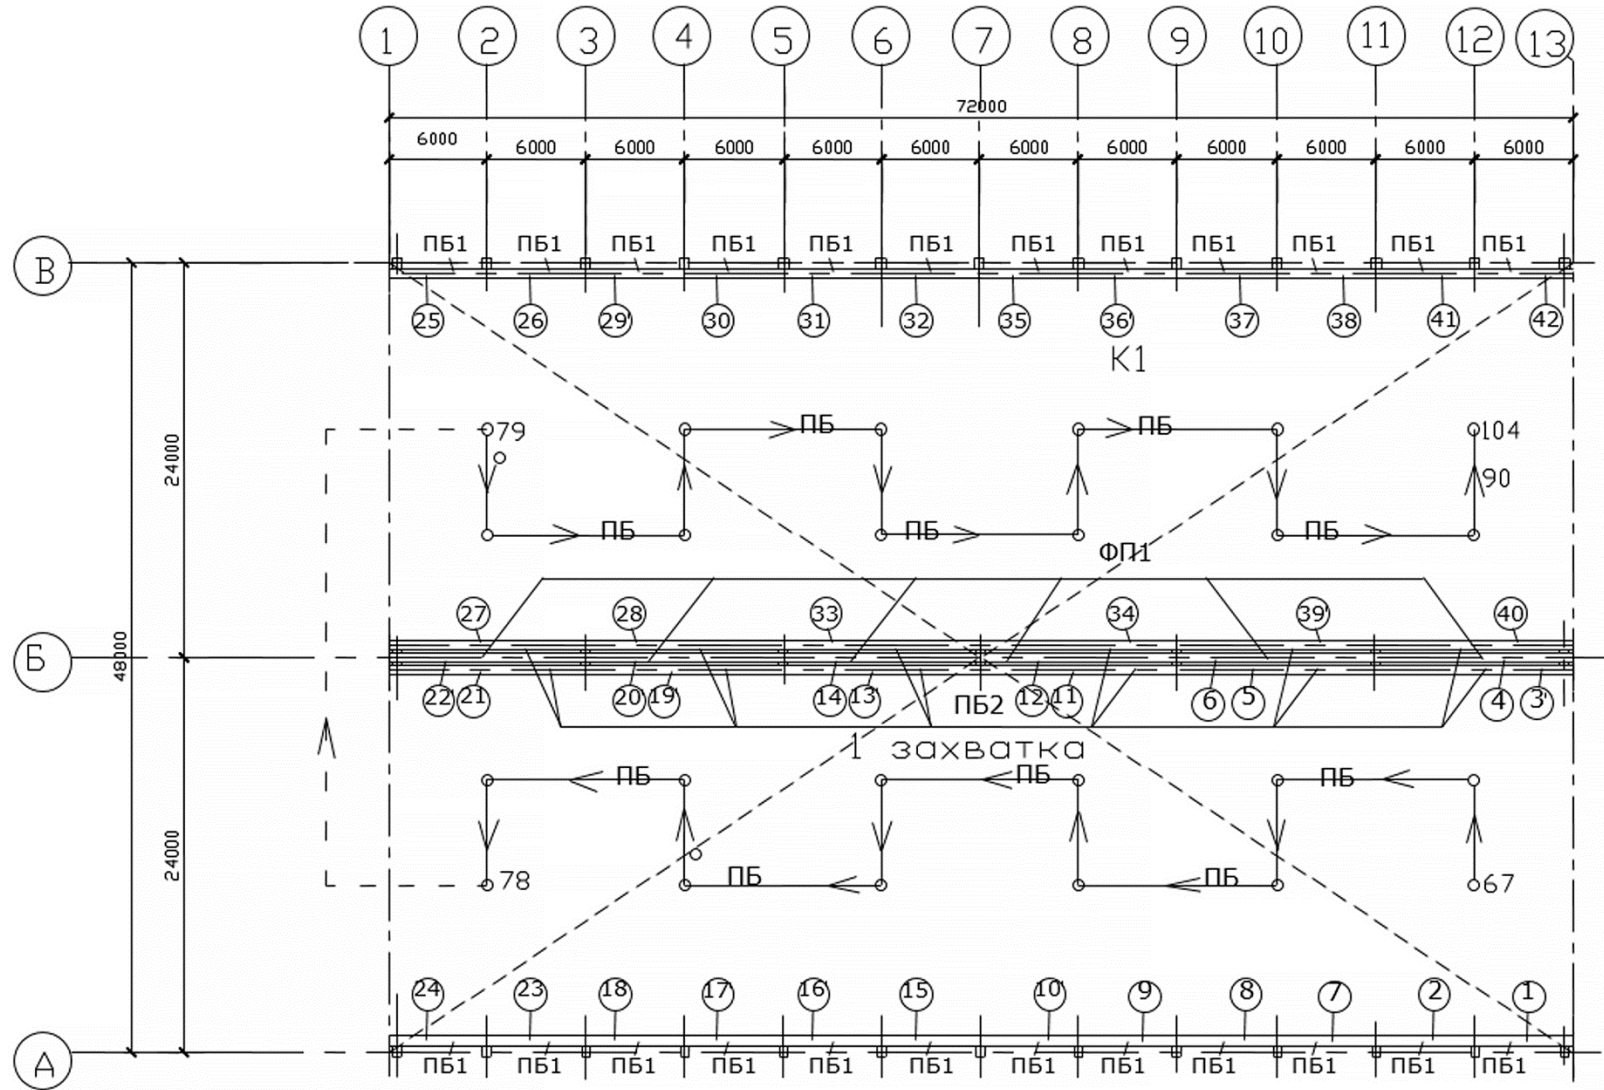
Порядок монтажа подкрановых балок ПБ1,2 и подстропильных ферм ФП1 на 1 захватке
